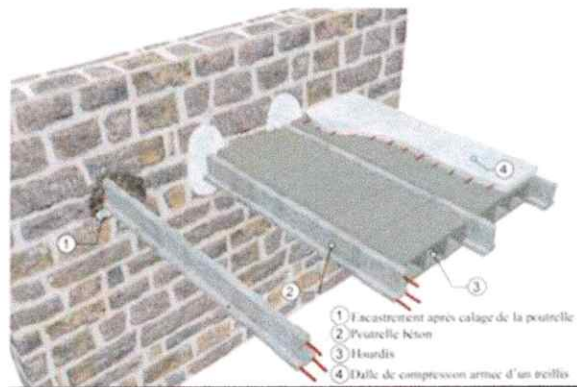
Plancher à poutrelle en béton armé encastrée dans le mur, source :
